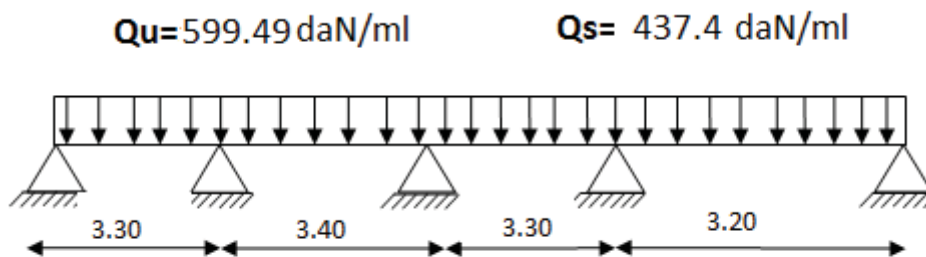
Schémas statiques des poutrelles de la terrasse
